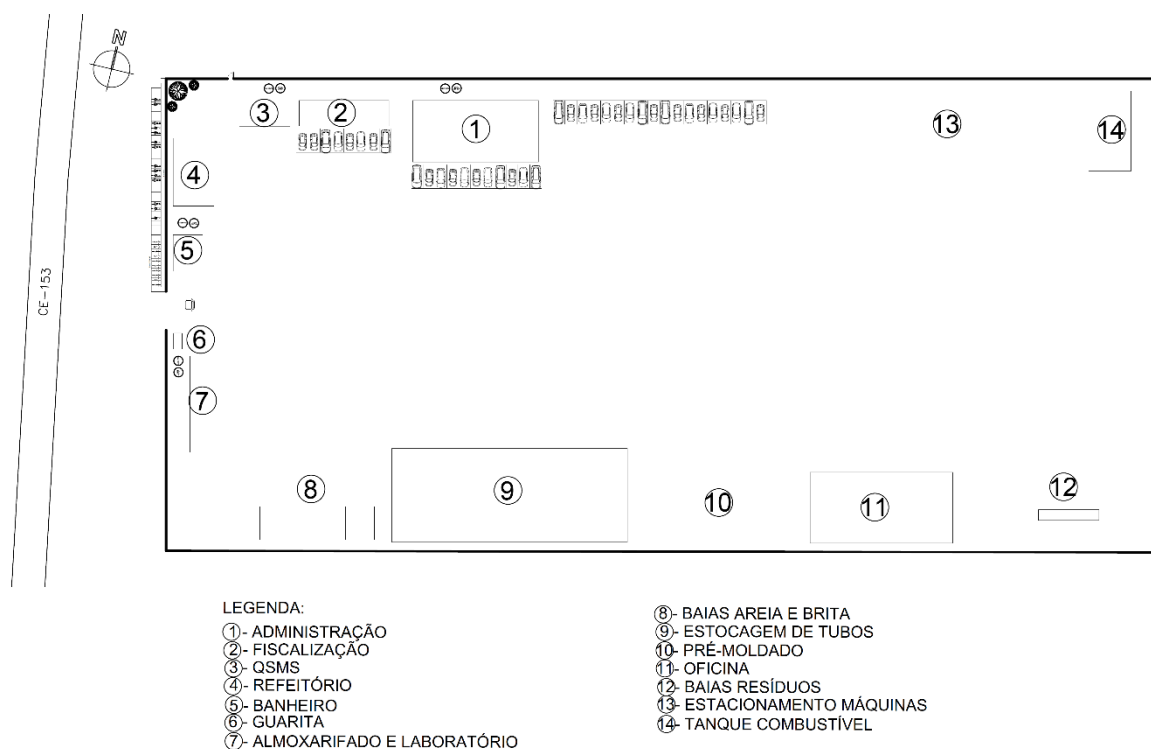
LAYOUT GERAL PREVISTO DO CANTEIRO DE OBRAS PARA EXECUÇÃO DO SAB – SC.
